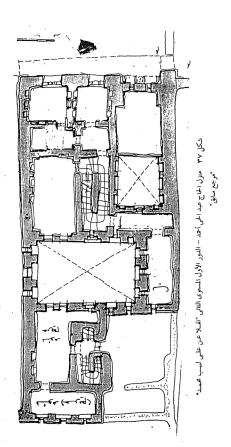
حامرت بدرب خلف الله - مسقط أفقى
